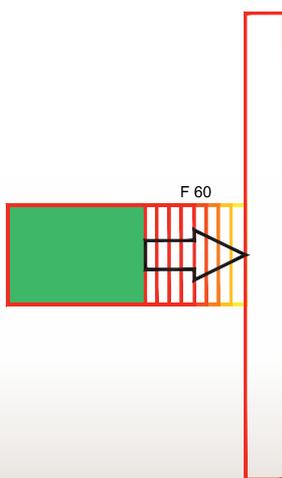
Clase F60 entre losa de piso y fachada de muro cortina.
